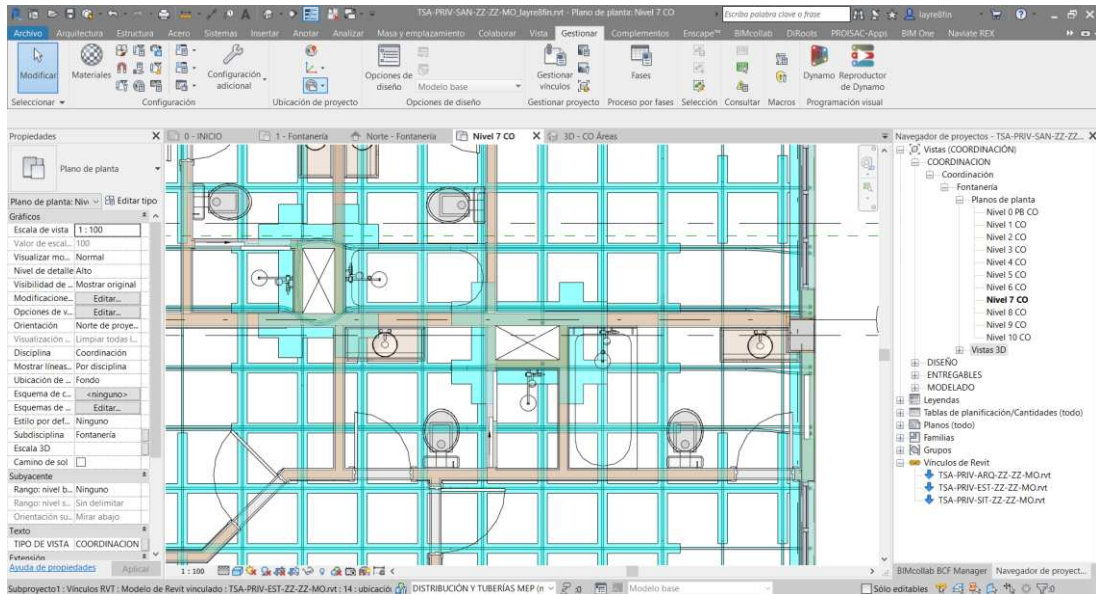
Plantilla de vista para coordinación estructura-sanitaria – Fuente: Elaboración propia
